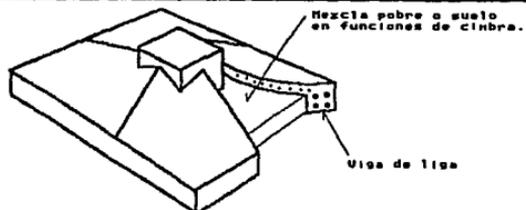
ZAPATA AISLADA PARABOLOIDE HIPERBOLICA
